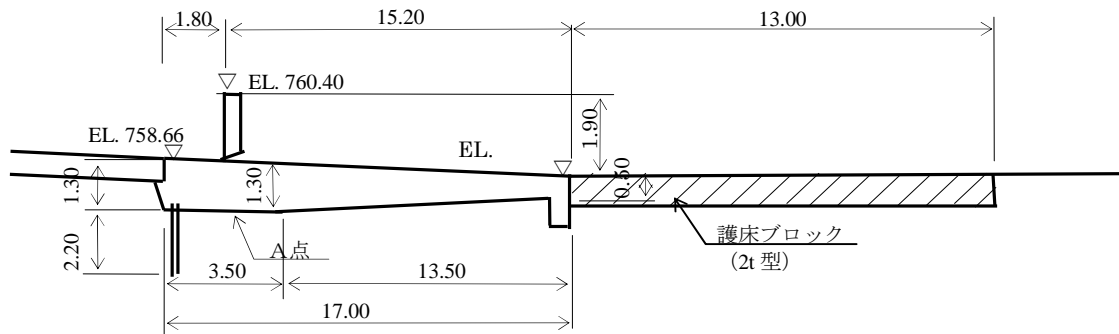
P5 頭首工 土砂吐エプロン標準断面図
